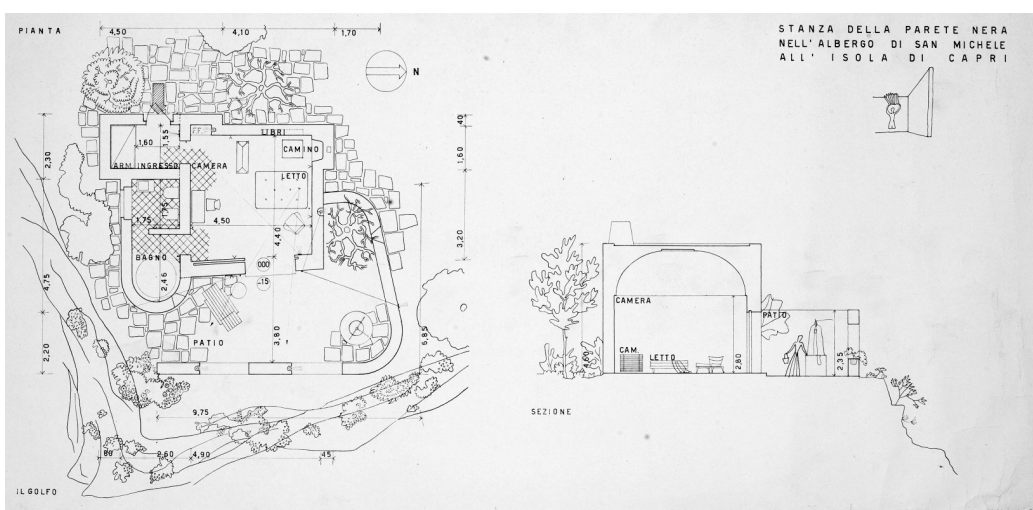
Stanza della parete nera: pianta e sezione (CSAC, Università di Parma).
